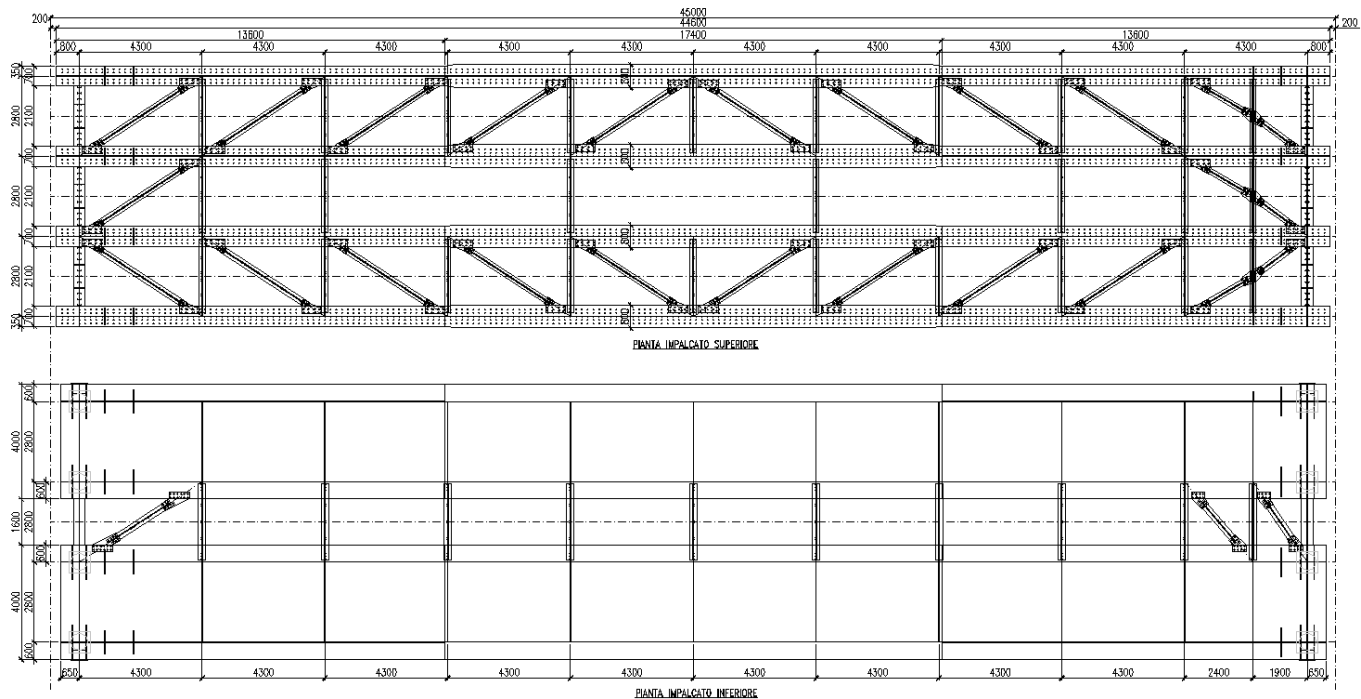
Pianta di impalcato (superiore ed inferiore)
